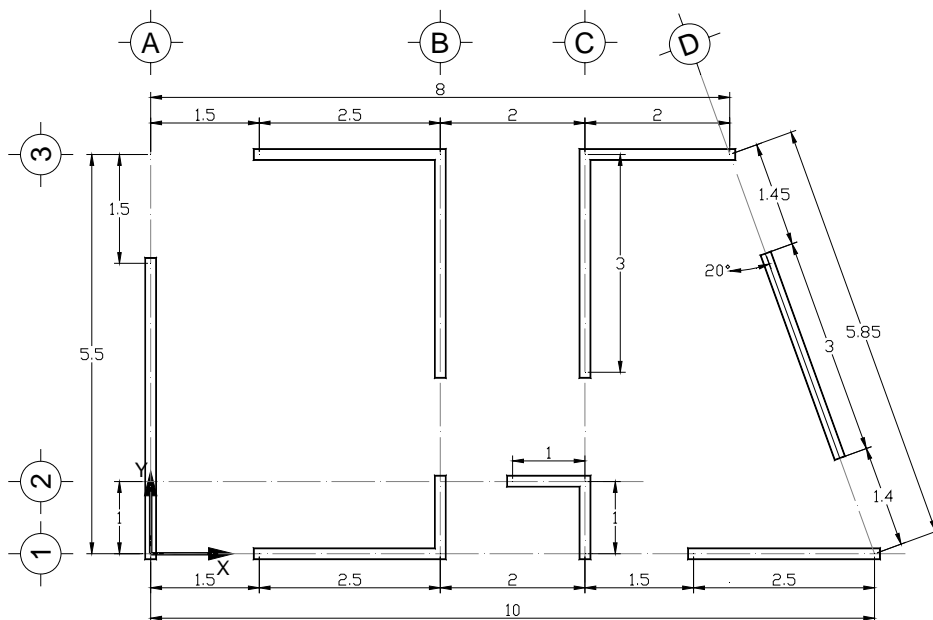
Planta típica de la casa, modelo *E3* (cotas en *m*)
